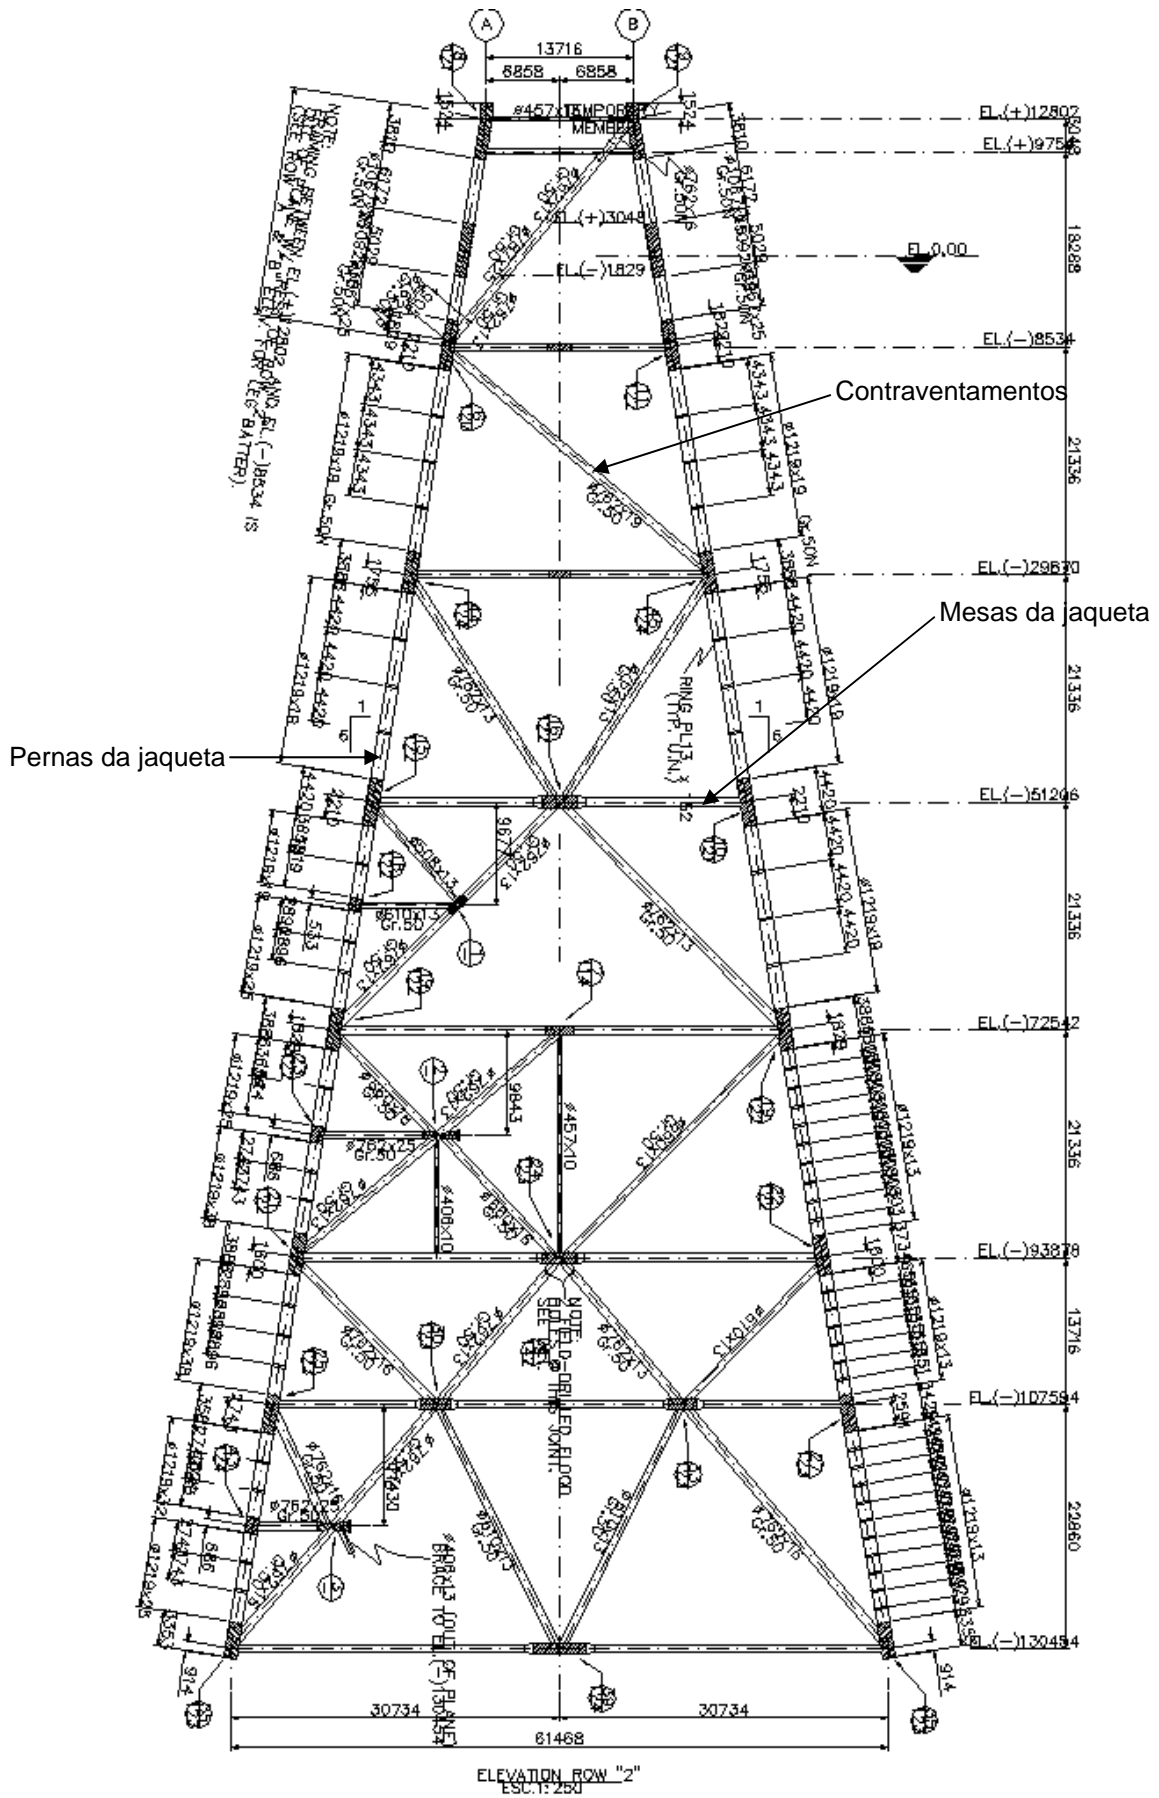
Jaqueta – Elevação do Eixo 2 (cotas em mm)
